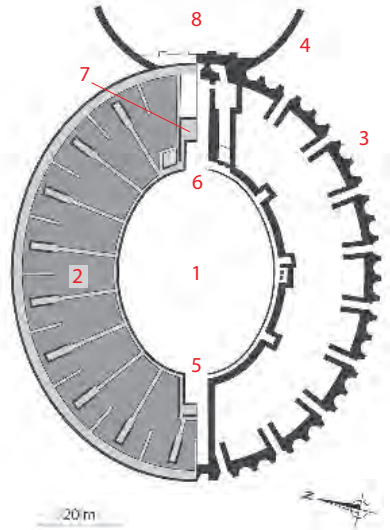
Amphitheater. Grundriss der jüngeren Bauphase (nach 165 n. Chr.); links Aufsicht, rechts Plan auf Fundamentniveau. Zur Zahlenlegende vgl. Abb. 49.
